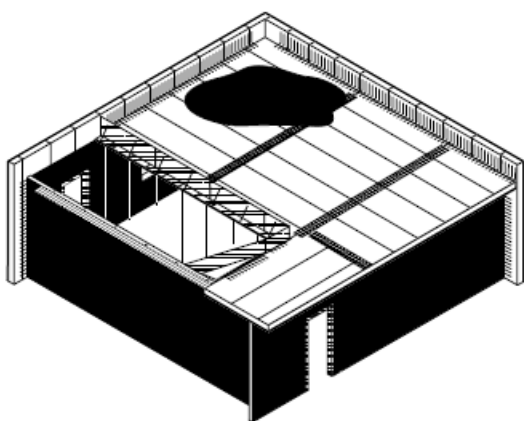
13. Vertido del hormigón en la capa superior (a)
